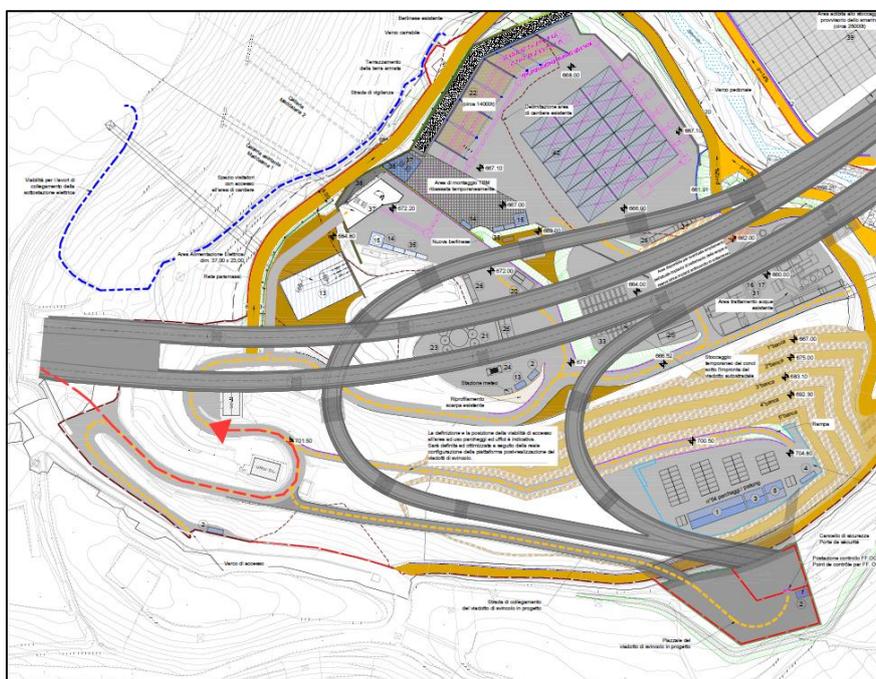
Accesso al cantiere in caso di utilizzo del varco autostradale a Maddalena
